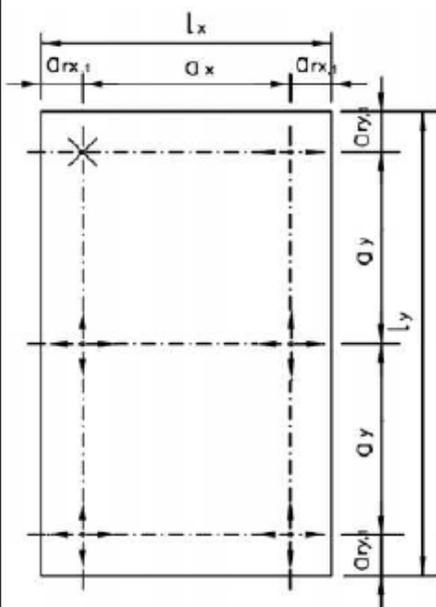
Fassadenplatte mit 6 Agraffen – Lagerungsart 2
